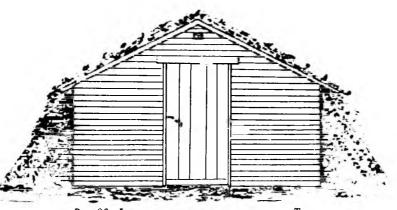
Фасадъ надземнаго плодохранилища г. Трусова.
